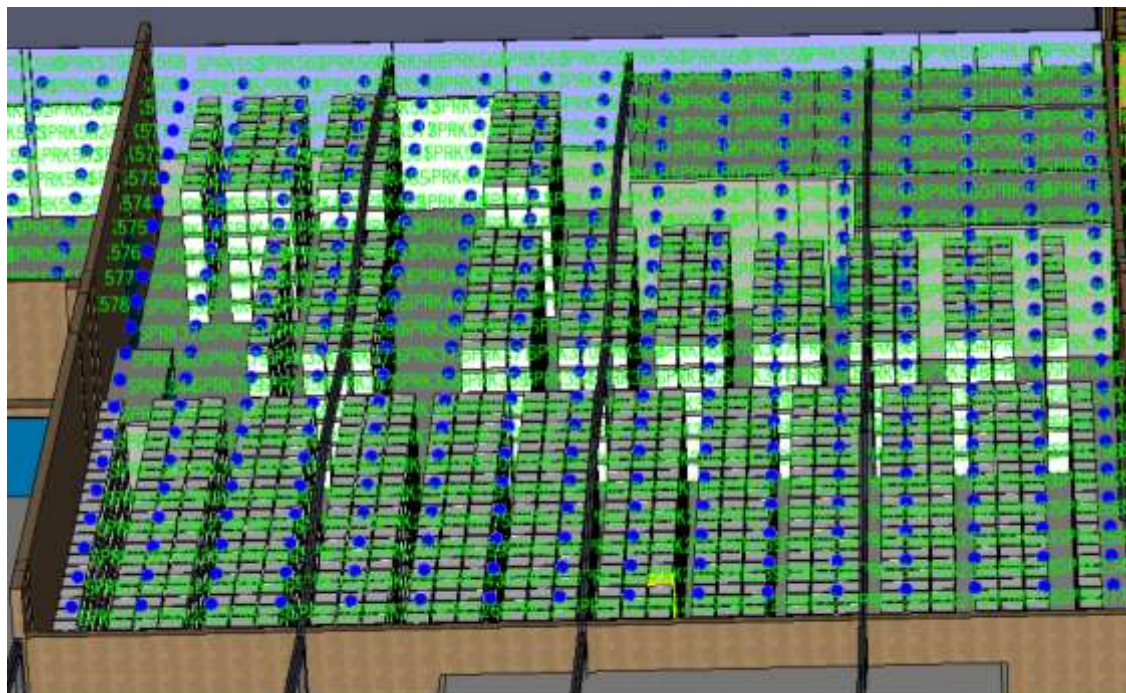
Pormenor dos sprinklers do armazém de material de embalagem 1
